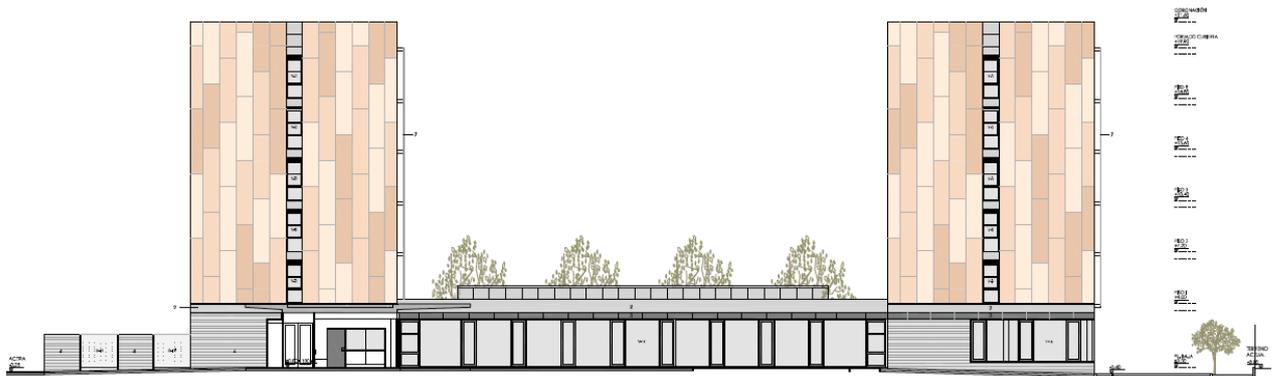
Fachada ventilada de chapa de zinc perforada (separados 40cm de la fachada) para protección solar. (fachadas Sur y Oeste)
